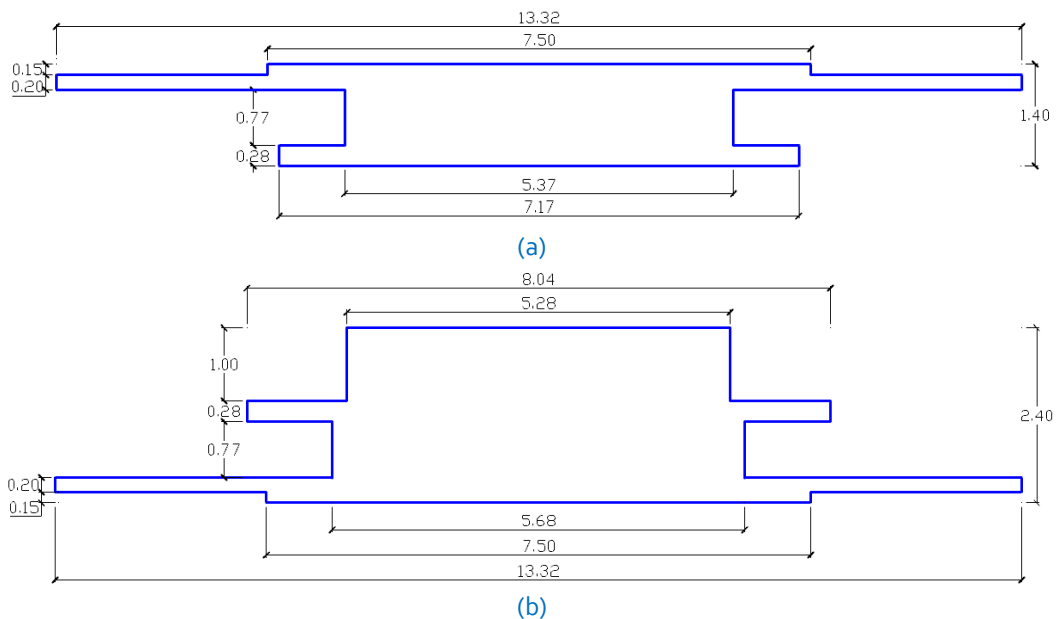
Sección Equivalente en centro luz Vano 3 (a) y sobre apoyo Pila 3 (b) del puente inicial.
